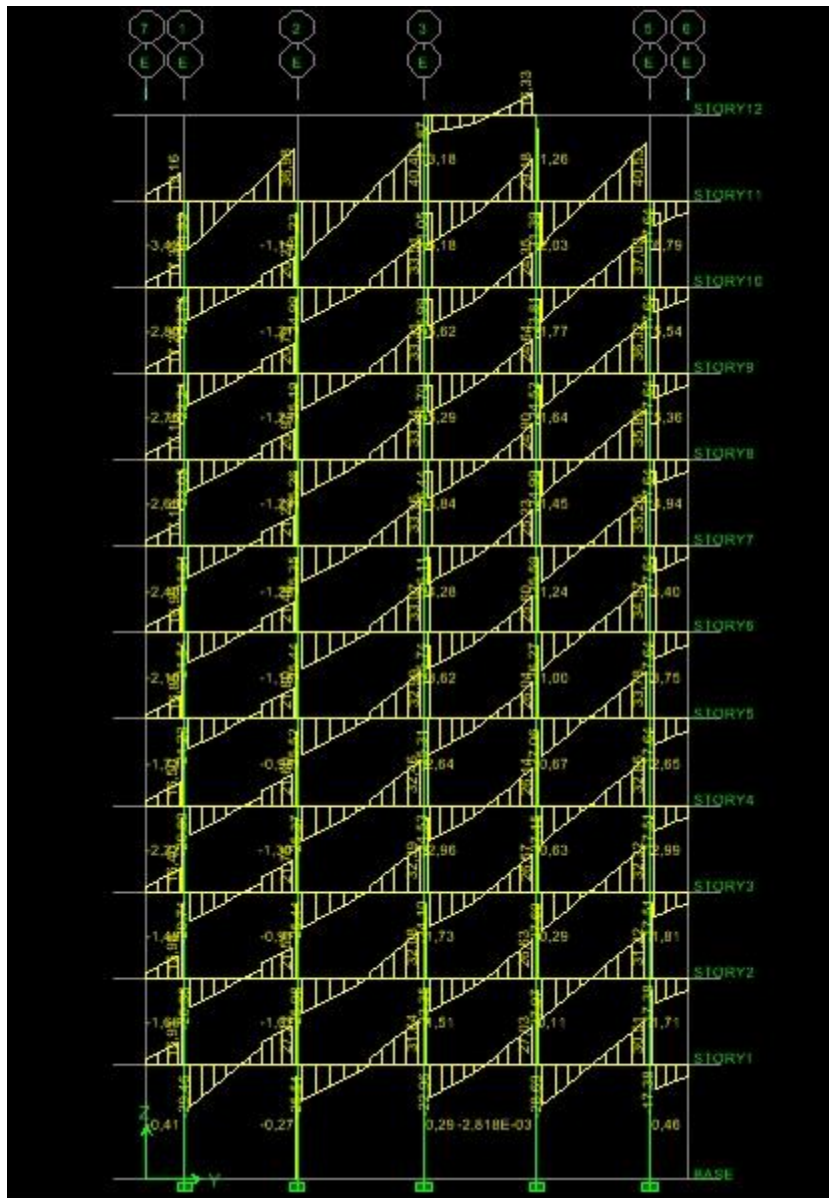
Exemple de l'effort tranchant des poutres, axe 2.
